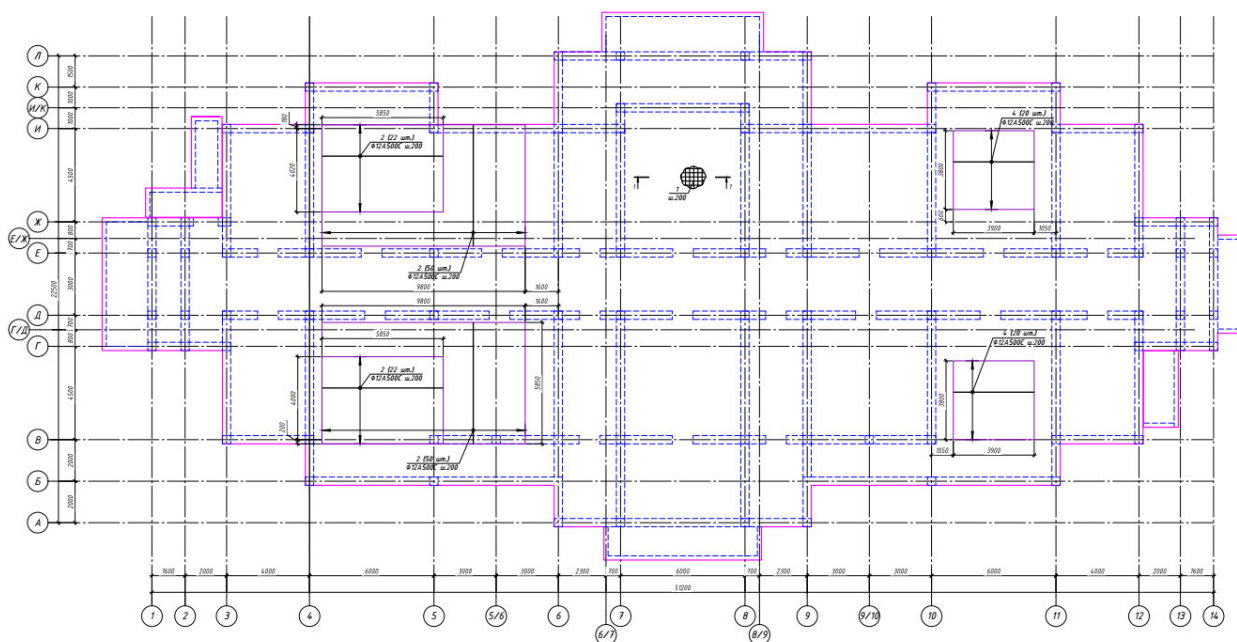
Схема раскладки верхней арматуры фундаментной ПЛИТЫ
